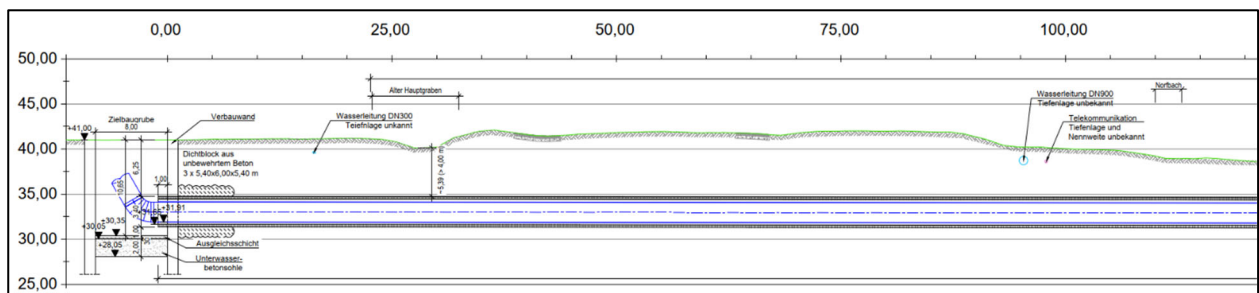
Knechtstedener Wald, Norfbach (Knechtstedener Graben) sowie Alter Hauptgraben, Längsschnitt, geschlossene Querung
